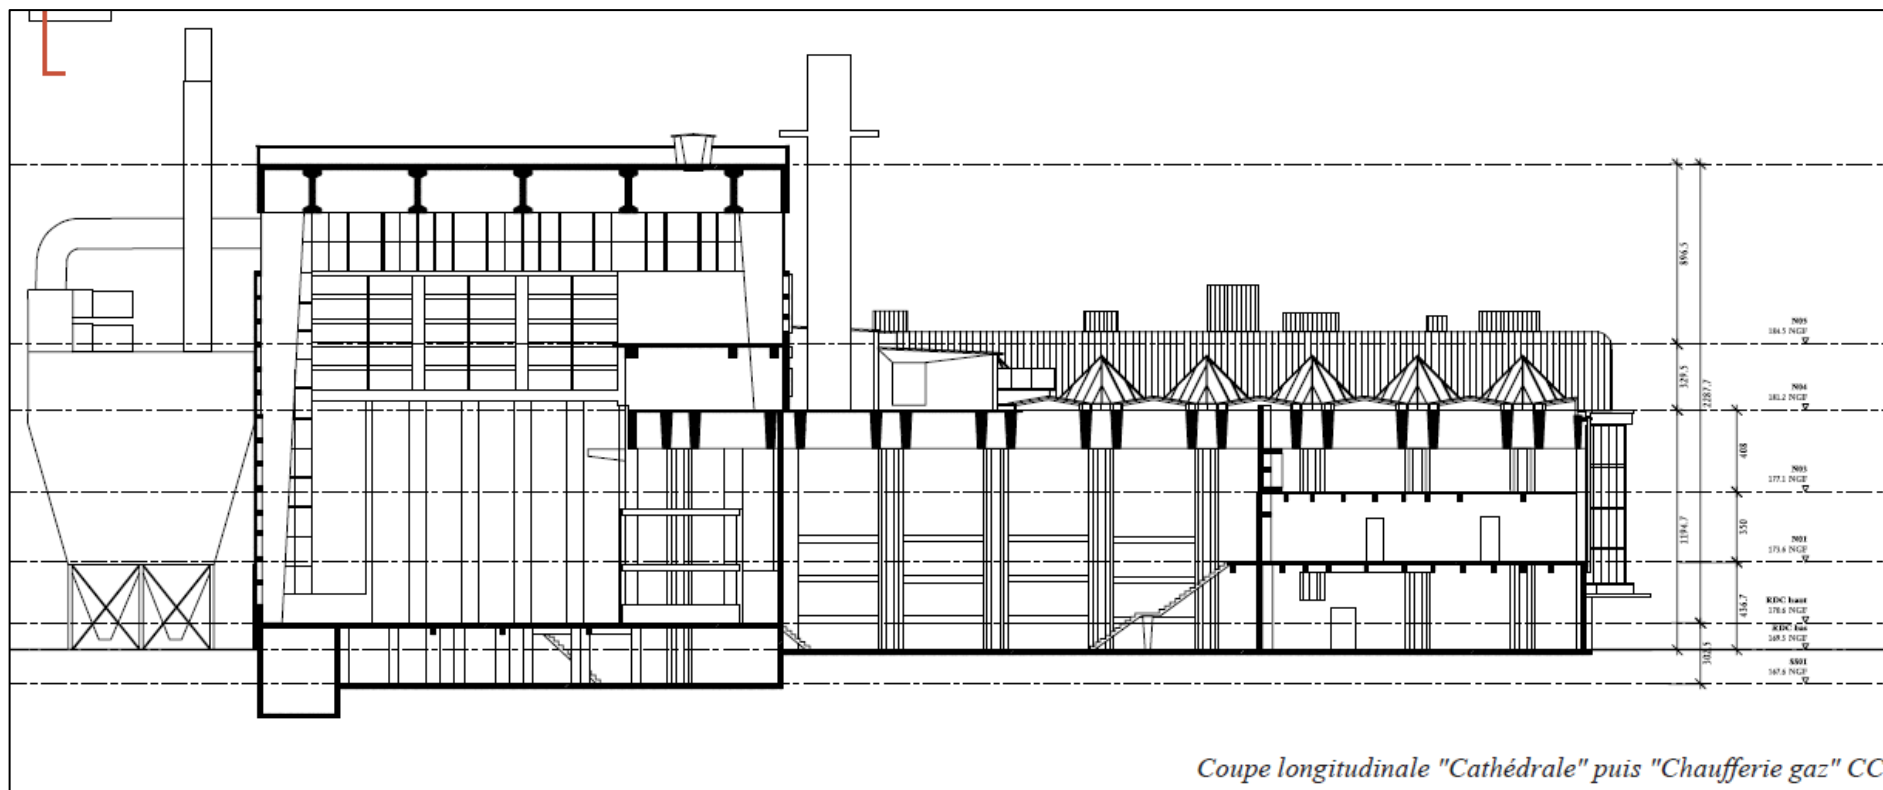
Plan coupe (source : Cahier des orientations pour le bâtiment de la Chaufferie de La Doua, février 2025)
